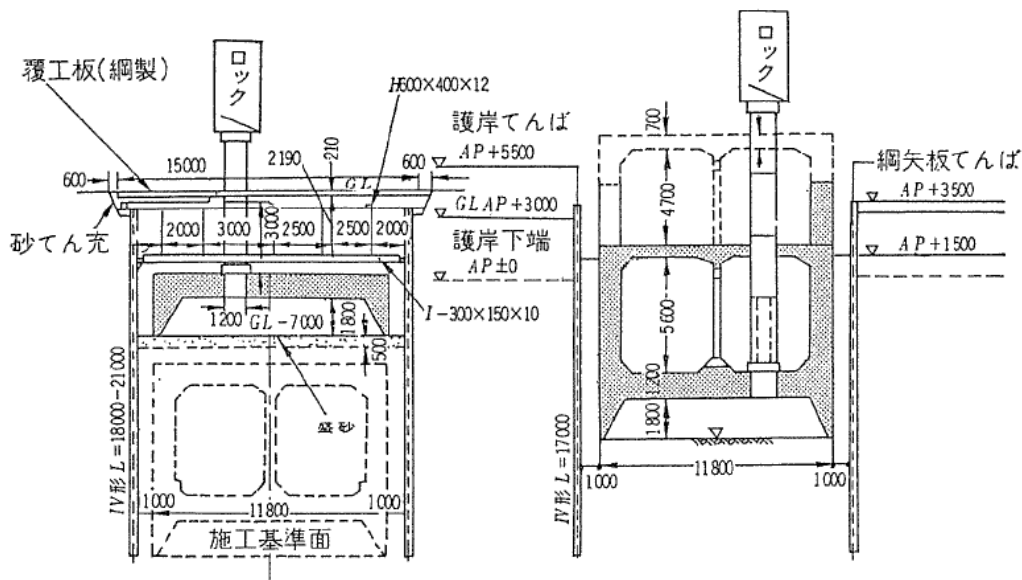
路下式潜函掘削標準断面図 図 4-2-6 路上式潜函掘削標準断面図
